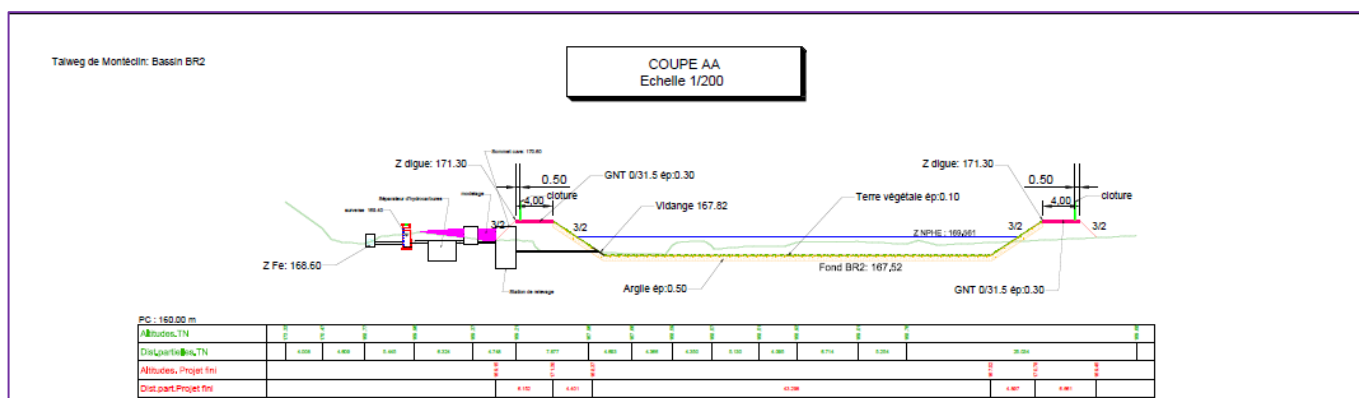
coupe transversale du BR2 (document entreprise DTP)
